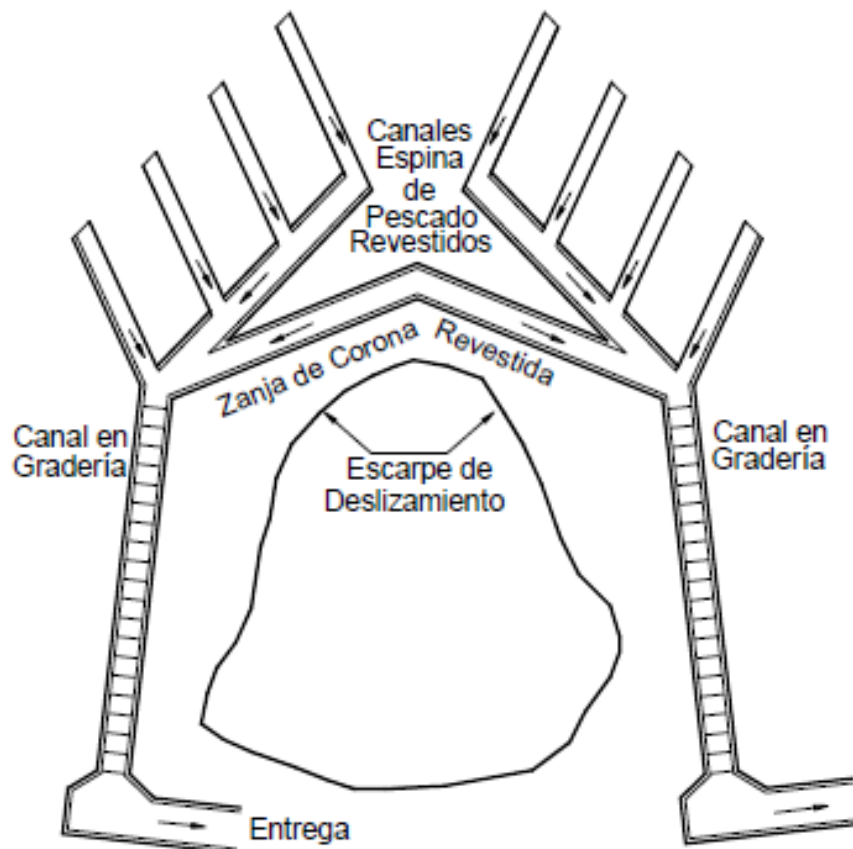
Esquema en planta de canales colectores Espina de Pescado (Suarez, 2010).
